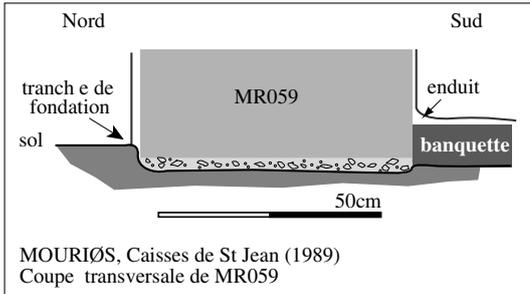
Mouriès, Les Caisses-de-Saint-Jean. Coupe transversale schématique du mur en terre, installé dans une tranchée de fondation peu profonde et remplie de cailloux.
